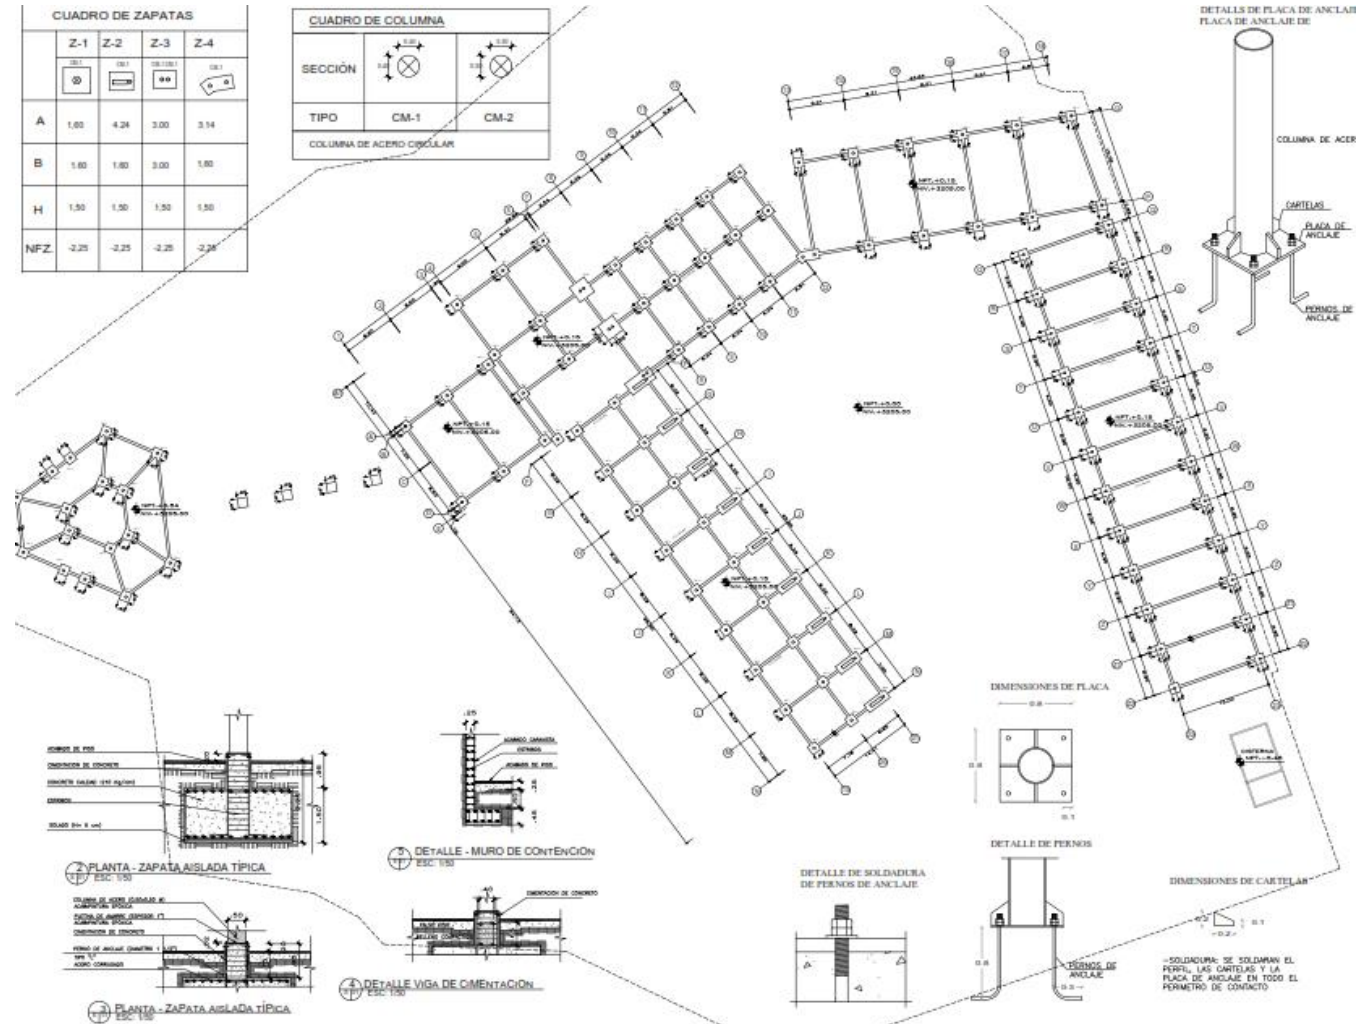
Plano de cimentación de todo el proyecto. Autoría propia.
